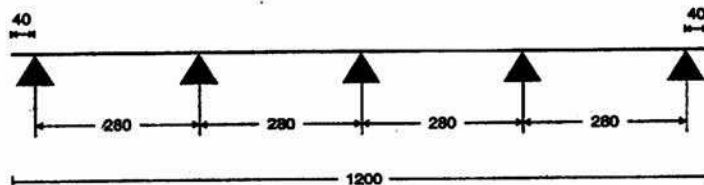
Afastamento de suportes de barramento: exemplo (dimensões em mm)
